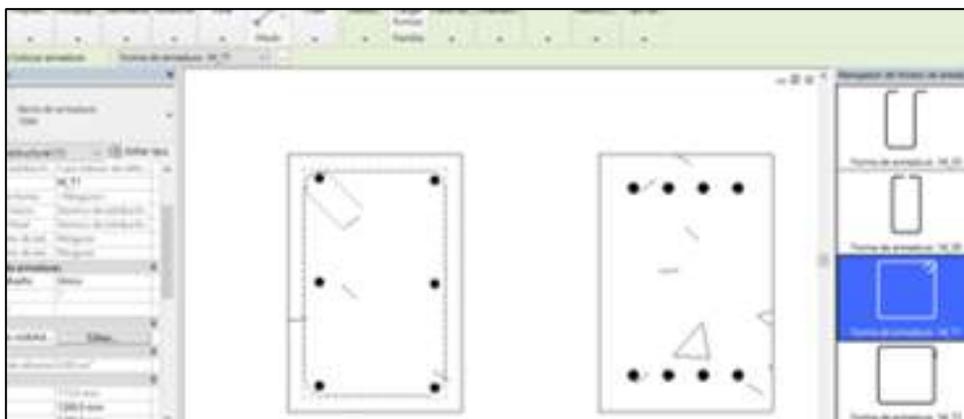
Modelamiento del acero de las columnas y vigas del edificio.
